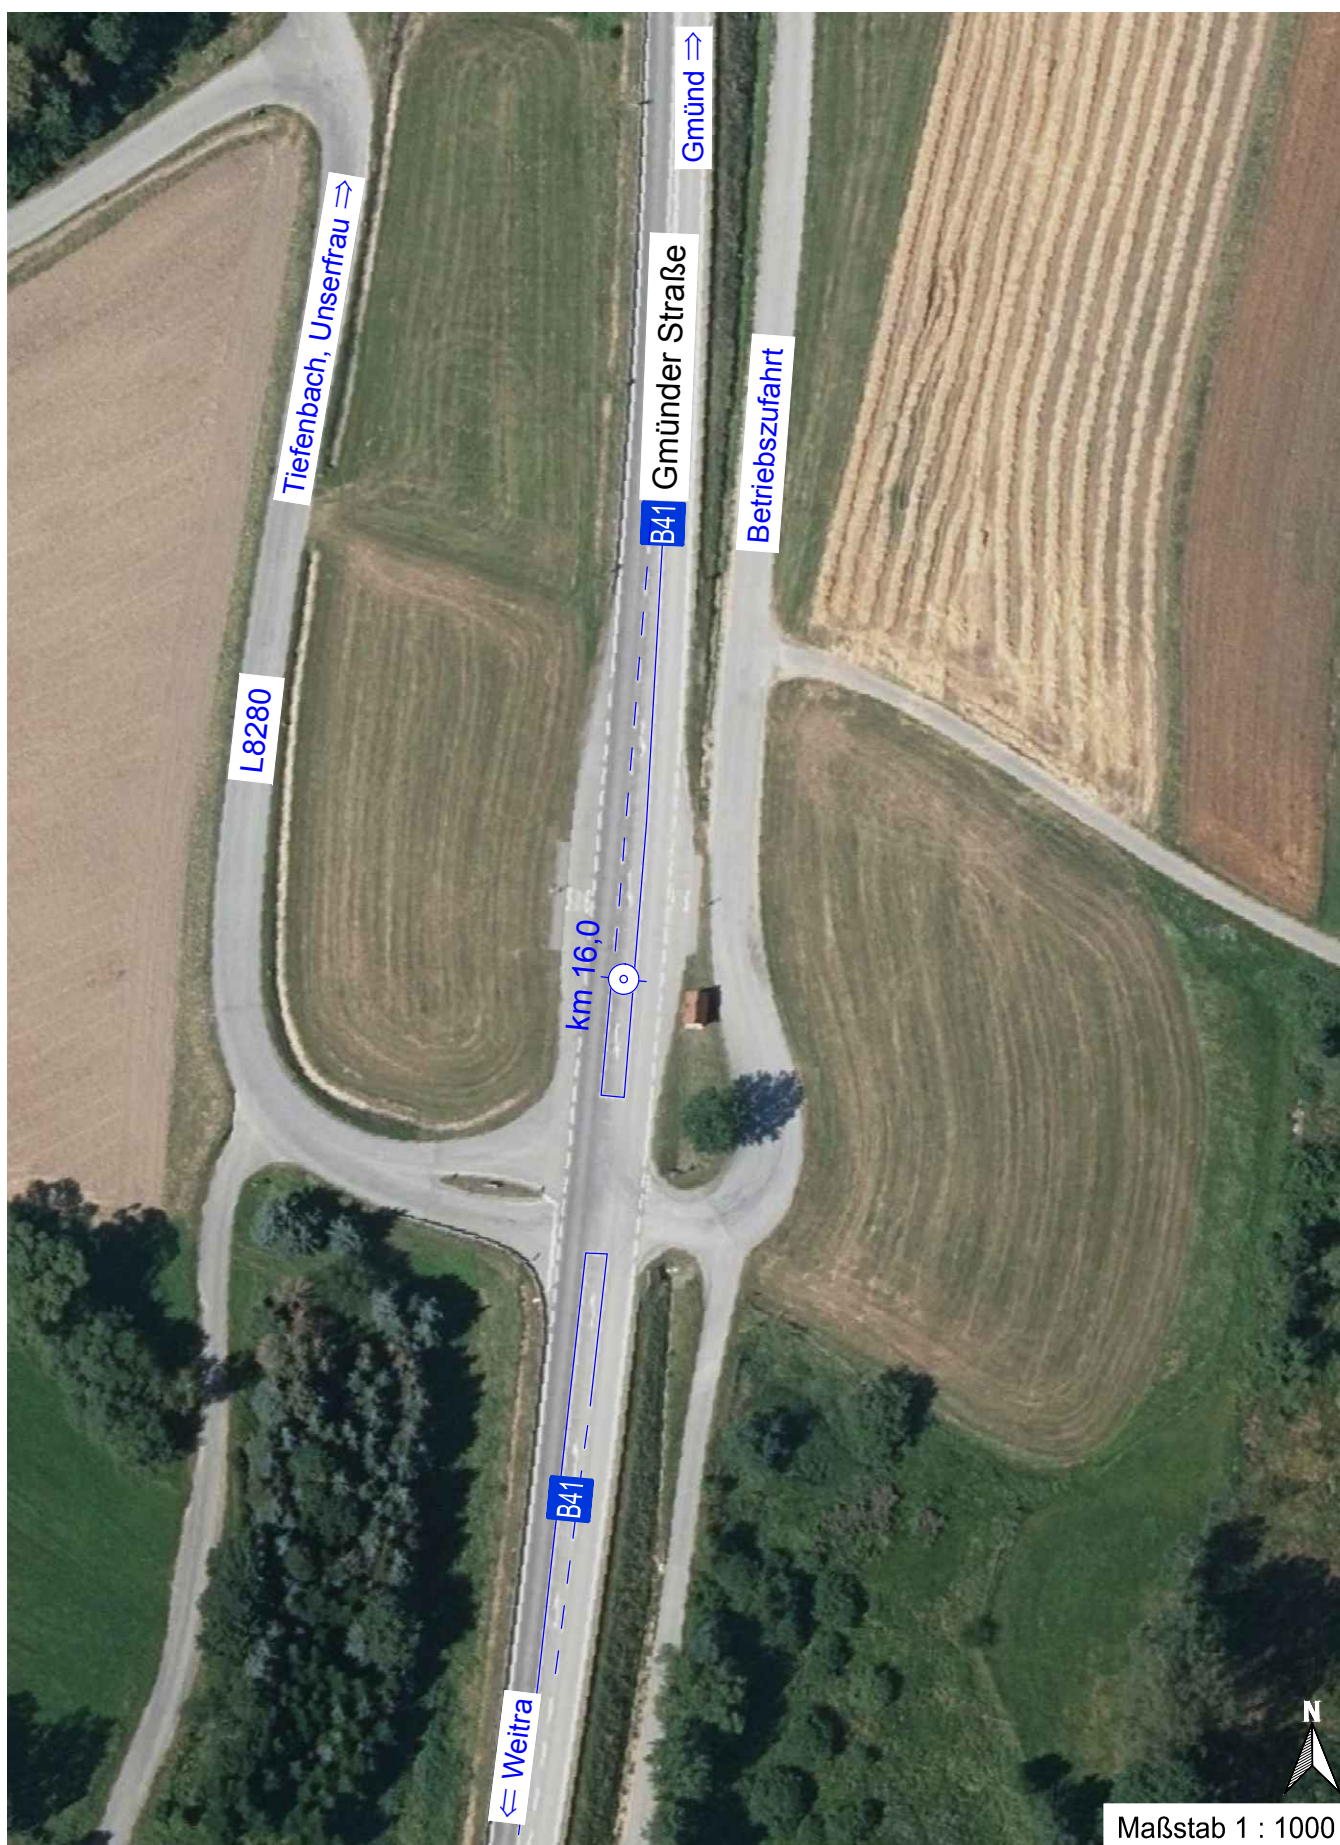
Luftbild Anschluss Betriebszufahrt an B41
